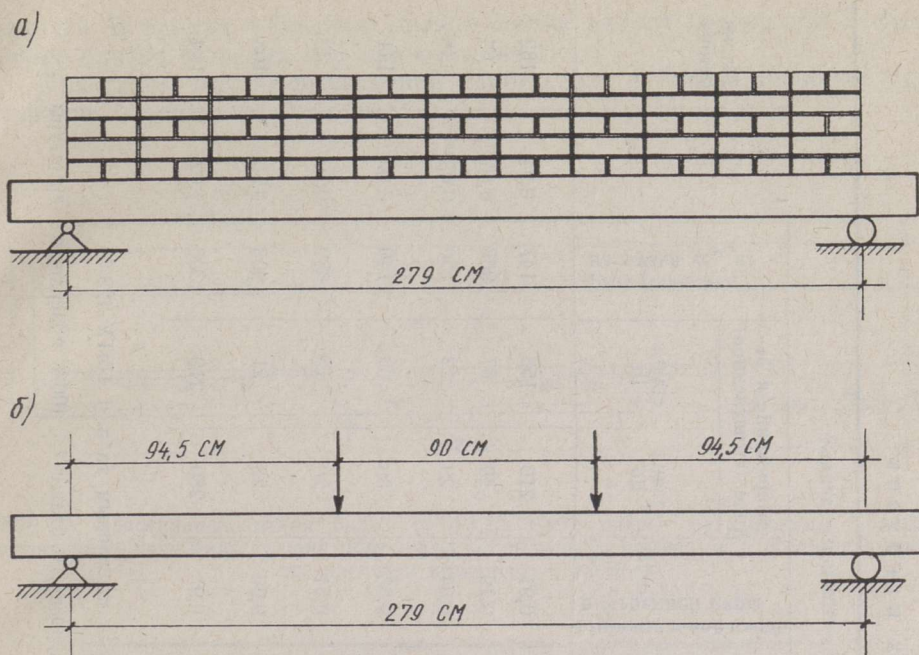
Схема нагружения балок: а — при испытании на длительное действие нагрузки; б — при испытании на разрушение.
